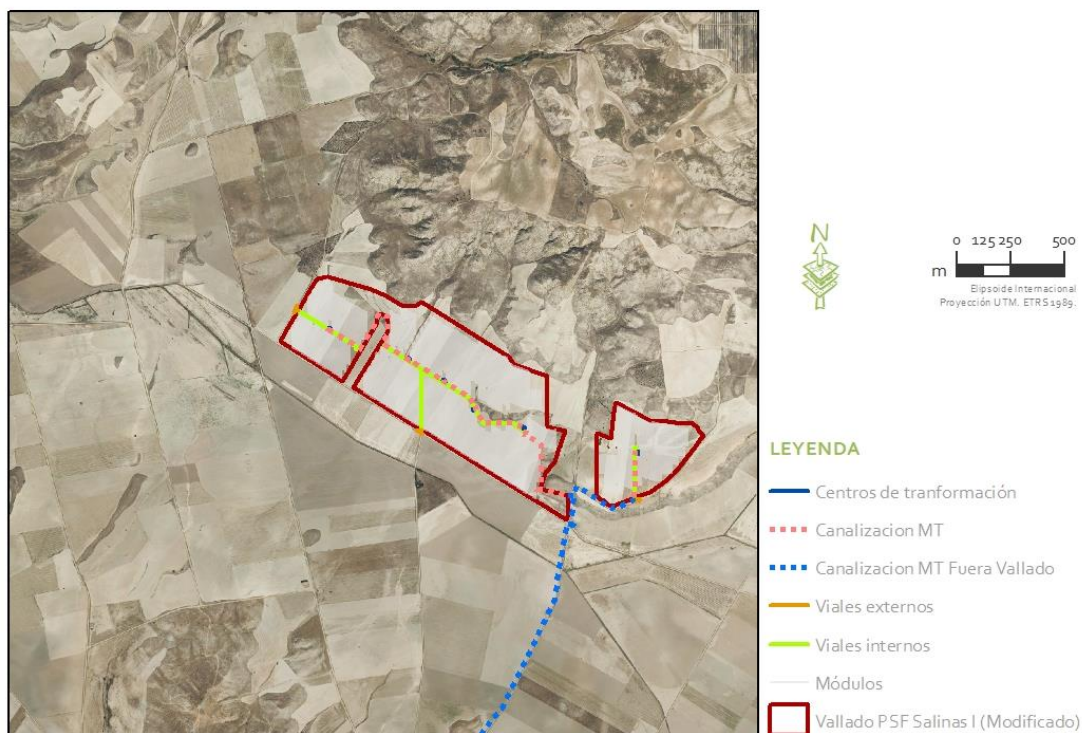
b. Diseño de la planta solar tras modificación (proyecto reformado).
